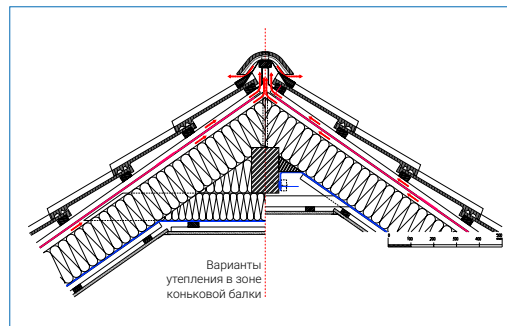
Конструкция утеплённой крыши с двумя вентиляционными зазорами
